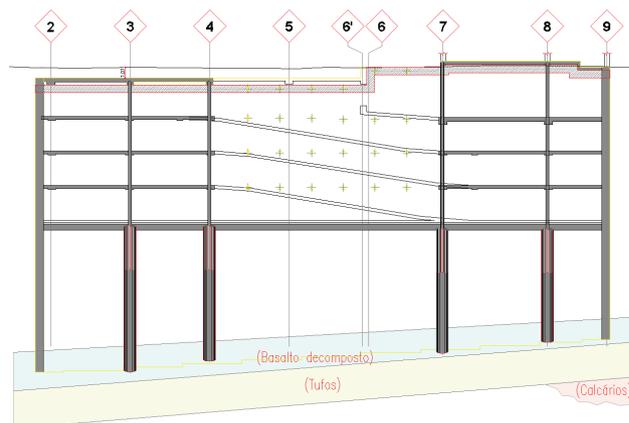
Estrutura *top/down*: corte transversal BB' (solução de projeto)
